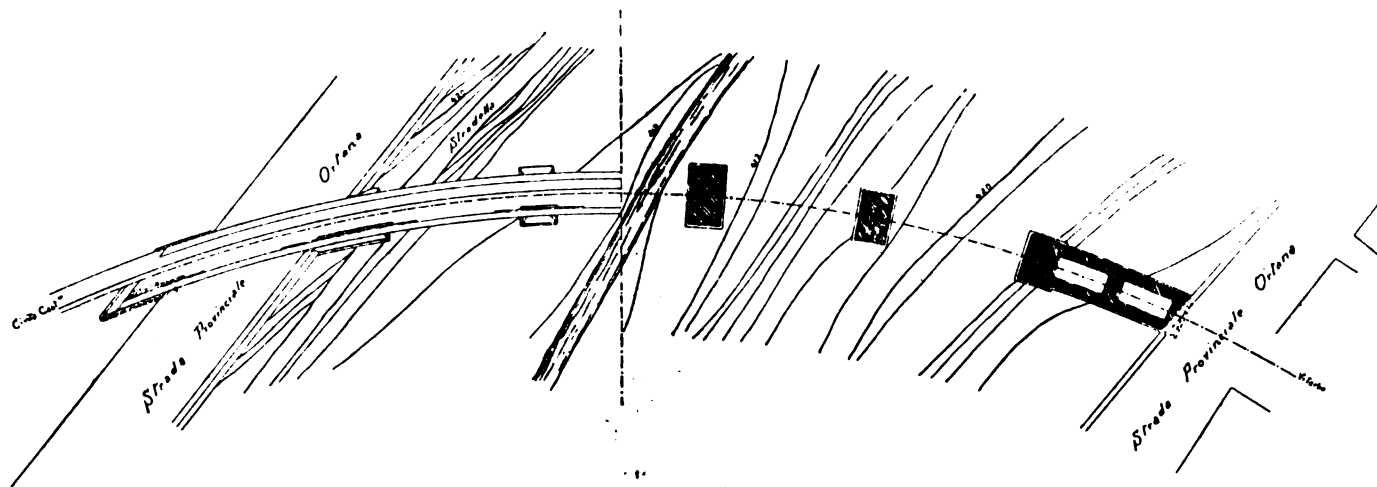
Viadotto di Bagnaia. - Pianta al piano del ferro ed al piano di fondazione.
